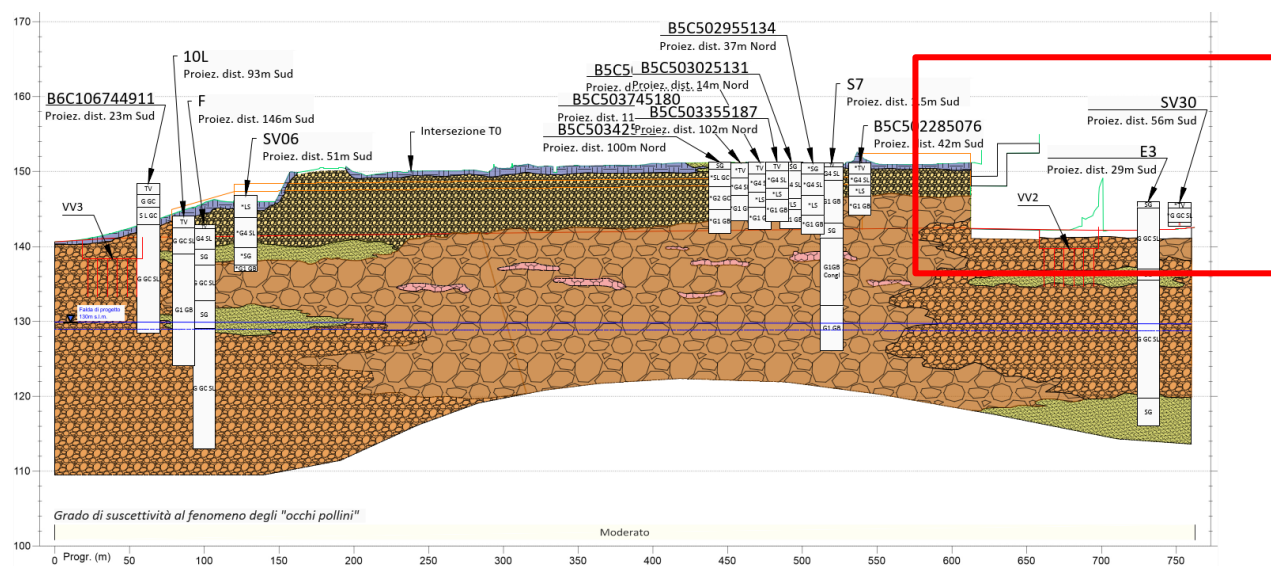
Estratto della sezione geotecnica LA (in rosso la zona interessata dall'intervento) (Rif. [4]).
